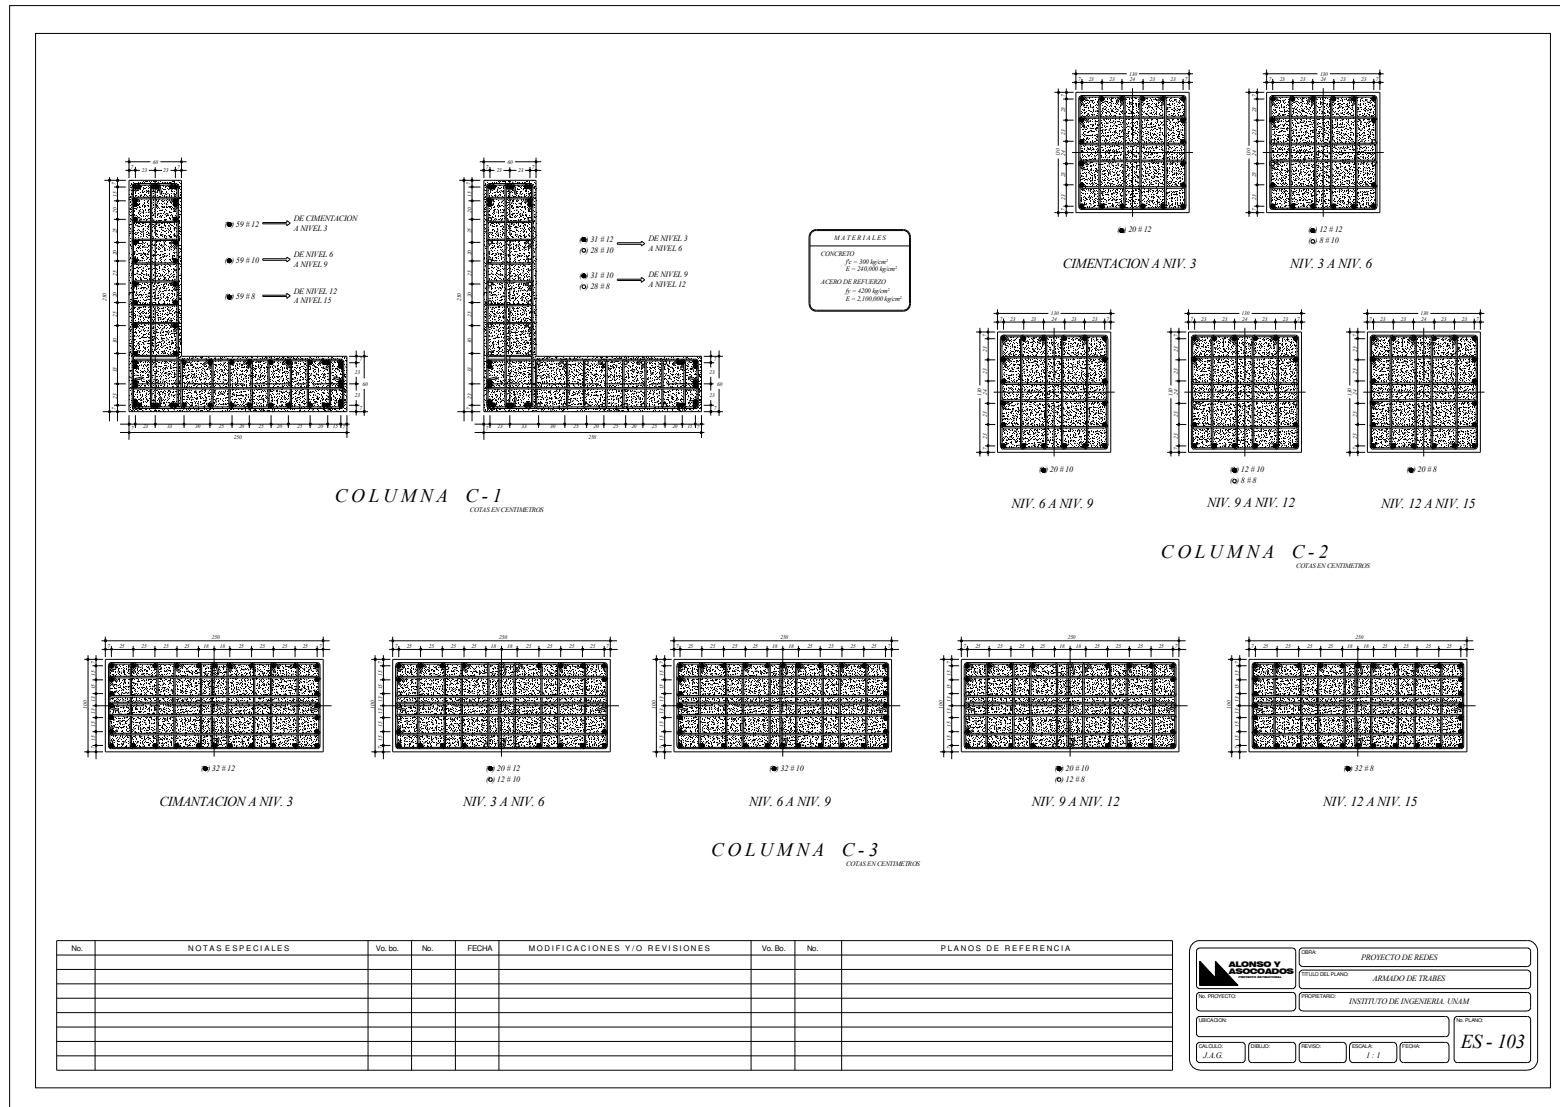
Secciones estructurales del edificio de 15 niveles
